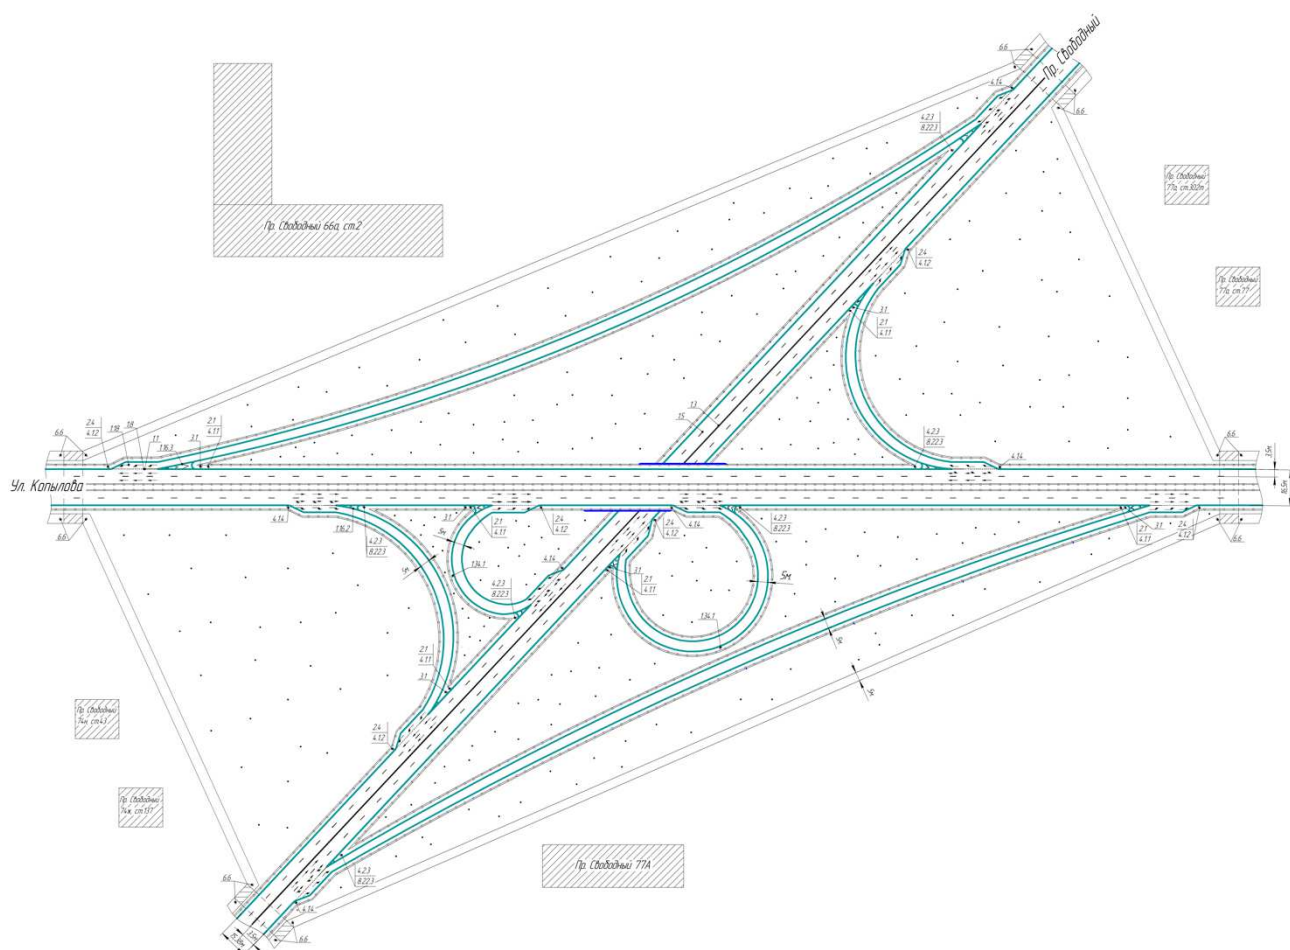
Схема предлагаемой транспортной развязки типа «неполный клеверный лист»
